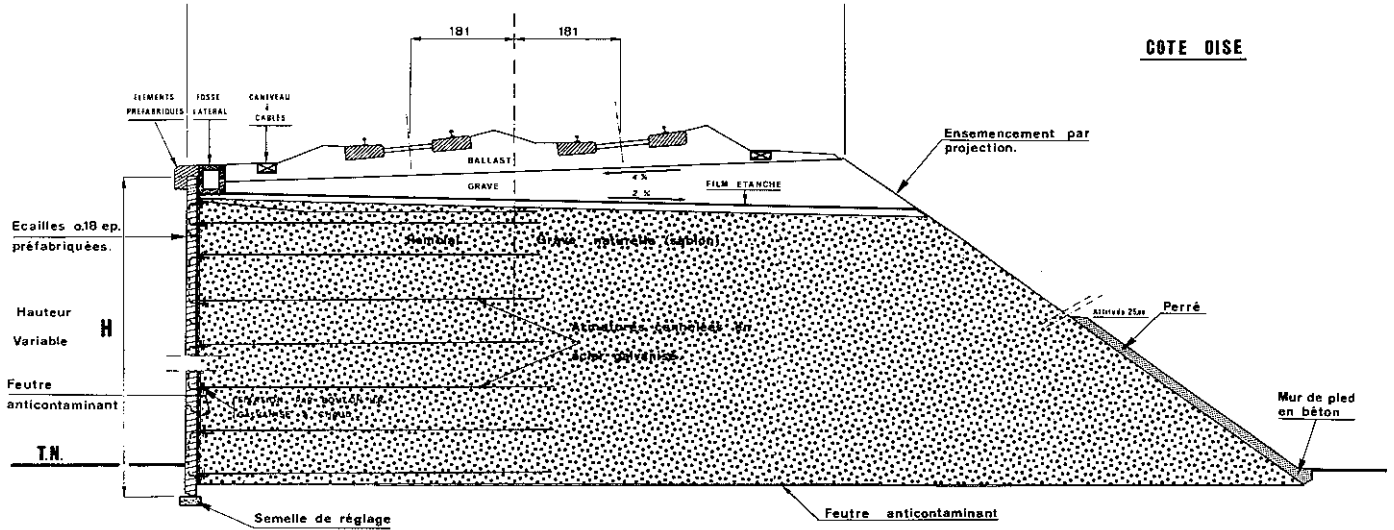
FIGURE : REMBLAI TERRE ARMÉE - PROFIL EN TRAVERS TYPE
